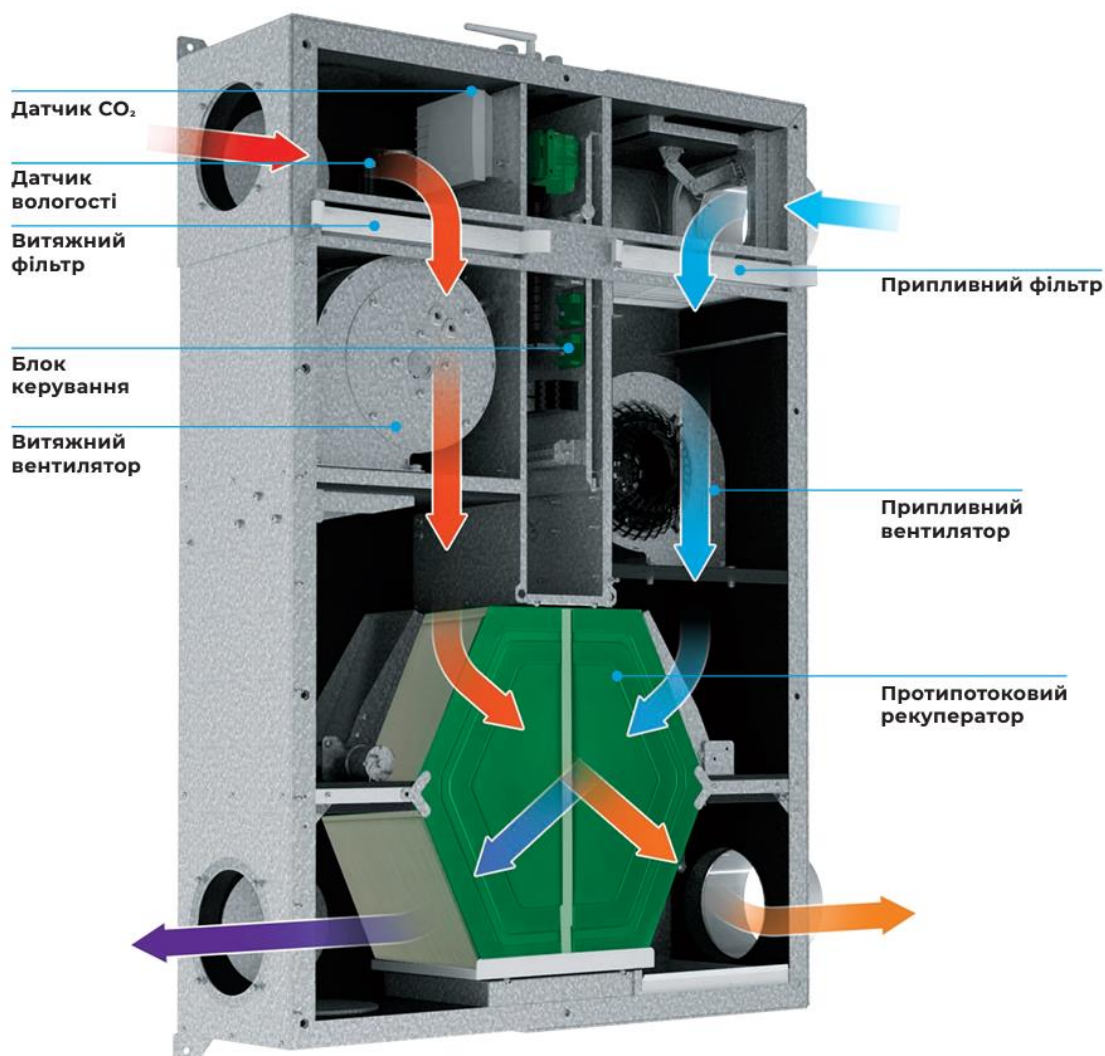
Конструкція припливно-витяжної установки [9]
